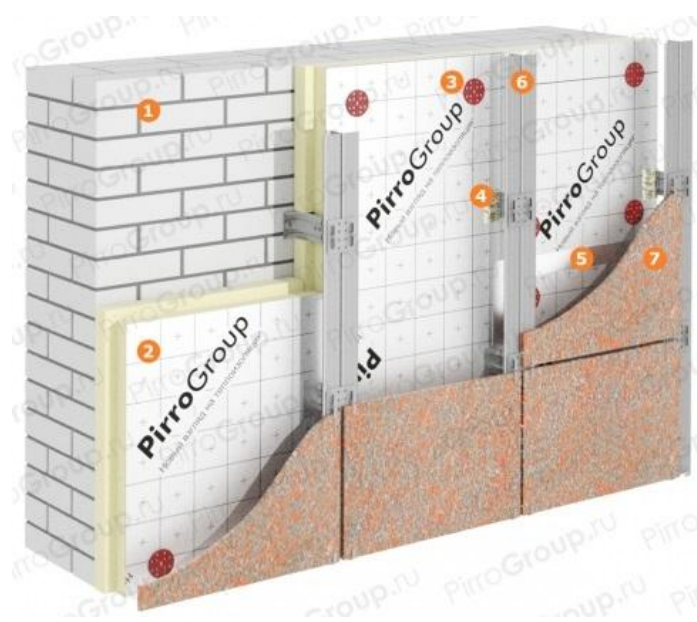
Утепление наружной стены теплоизоляцией из PIR-плит:
